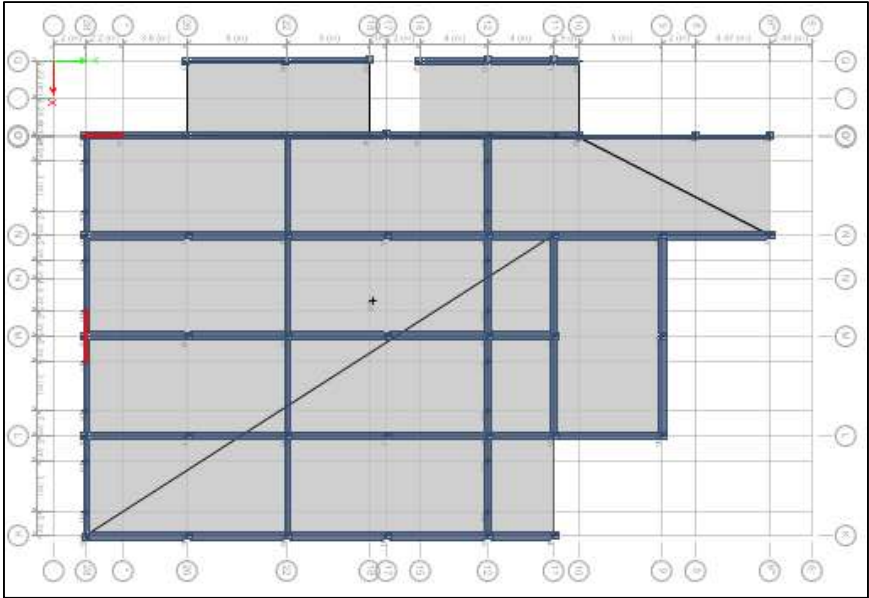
Planta N+0.00 Estructura 5.31 Hotel
